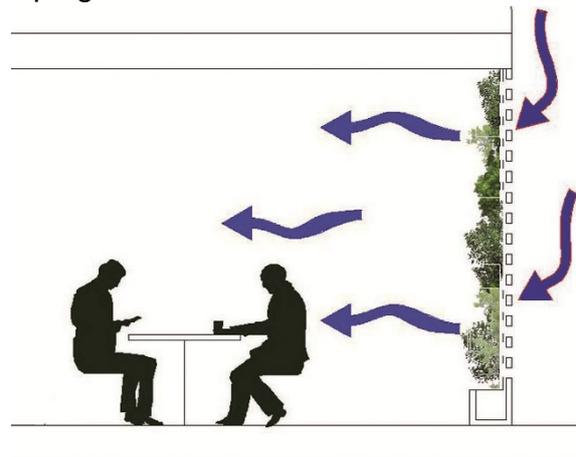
Corte esquemático de muro verde. Fuente: Archivo propio.
